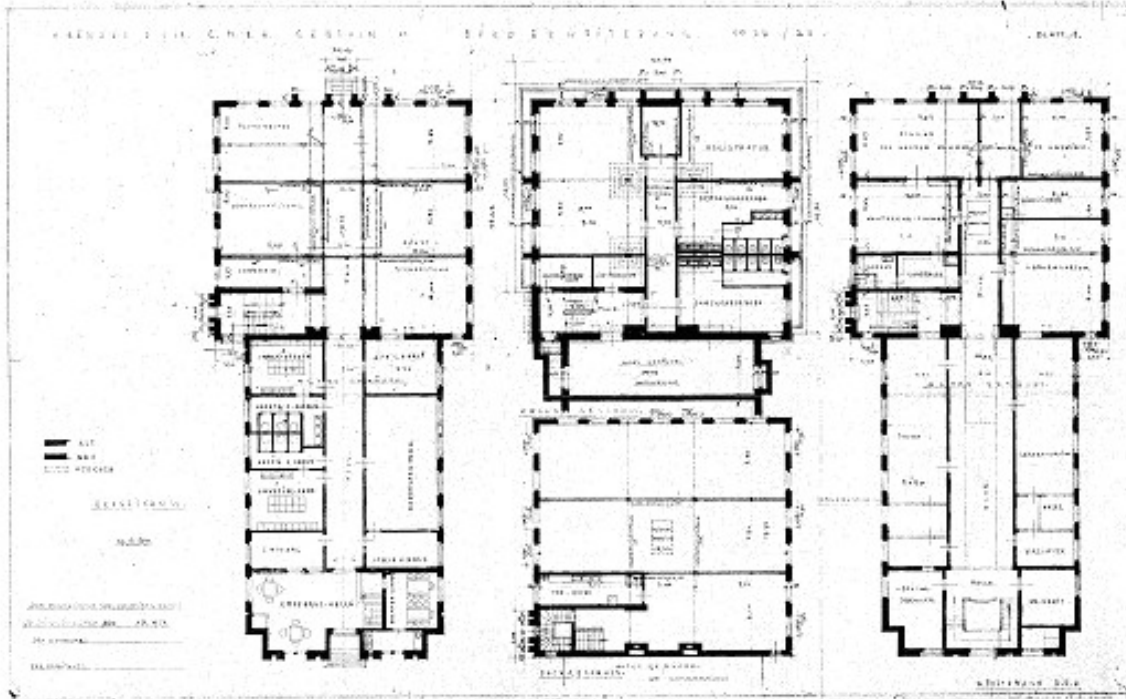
Bürogebäude – Grundrisse von 1927 – Architekt: Walter Furthmann (links: Erdgeschoss/ Alt- und Neubau, Mitte: Keller- und Dachgeschoss/ Neubau, rechts: Erstes Obergeschoss/ Alt- und Neubau)
